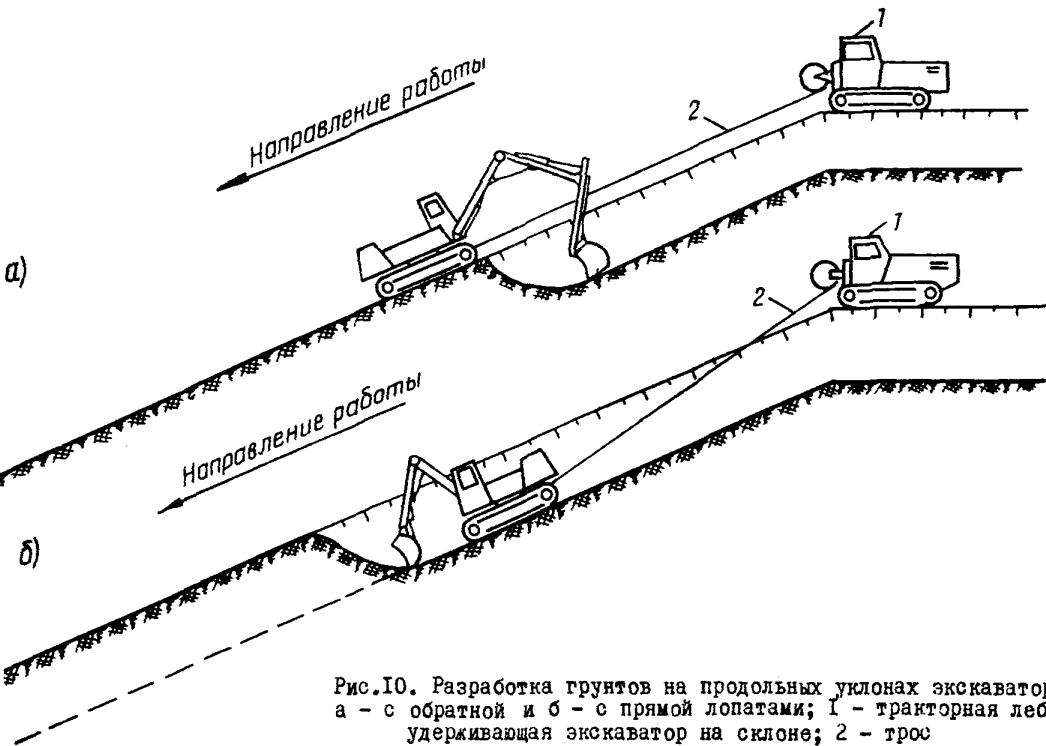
Разработка грунтов на продольных уклонах экскаваторами:
